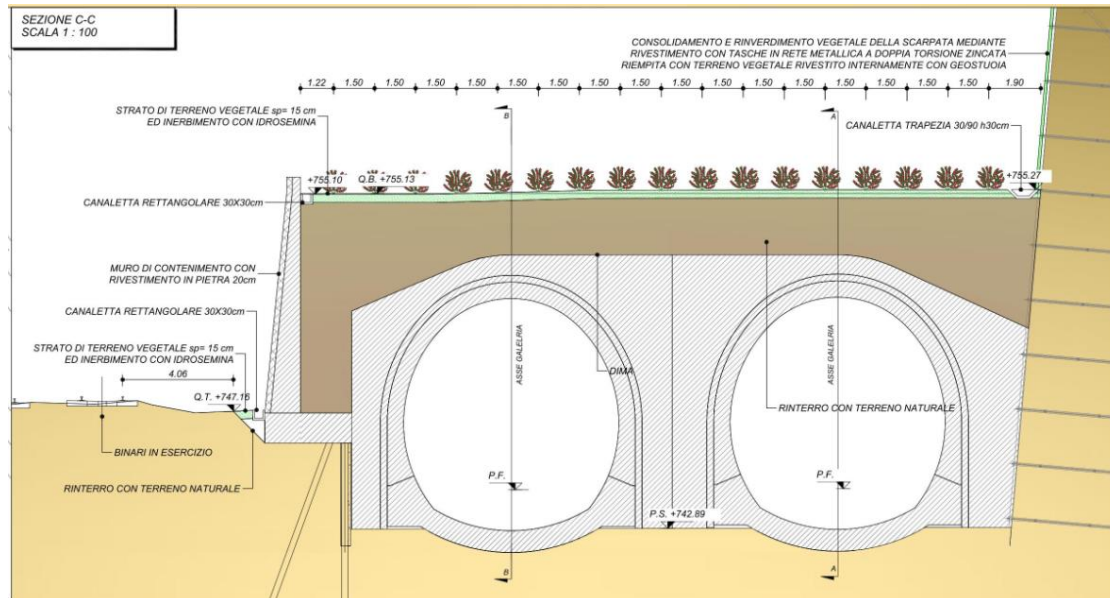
Opere a verde – Sezione di progetto imbocco Galleria Scaleres – Imbocco Nord.
